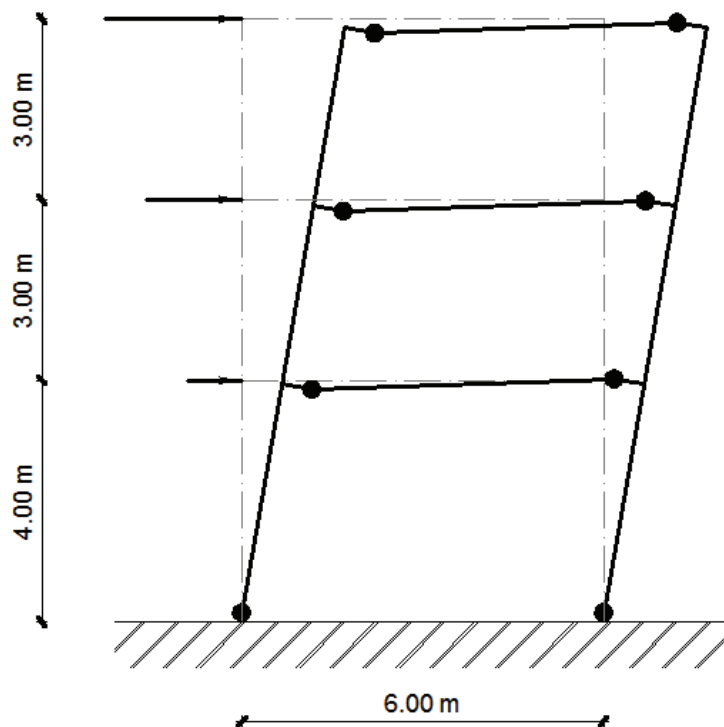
Mecanismo de colapso “*viga débil - columna fuerte*”
